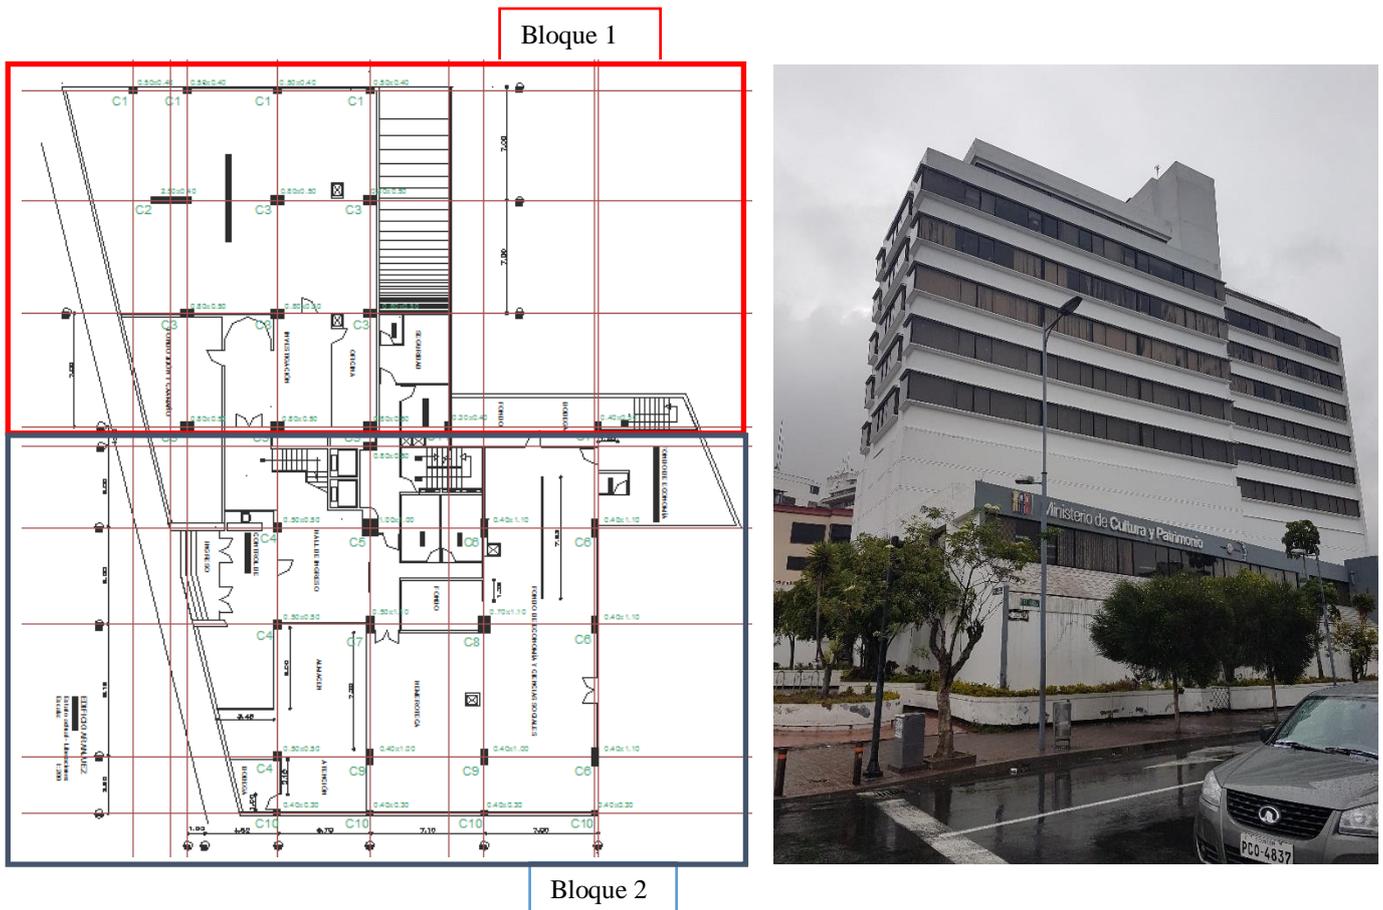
Planimetría Edificio Aranjuez. (Bloque 1 & 2)
